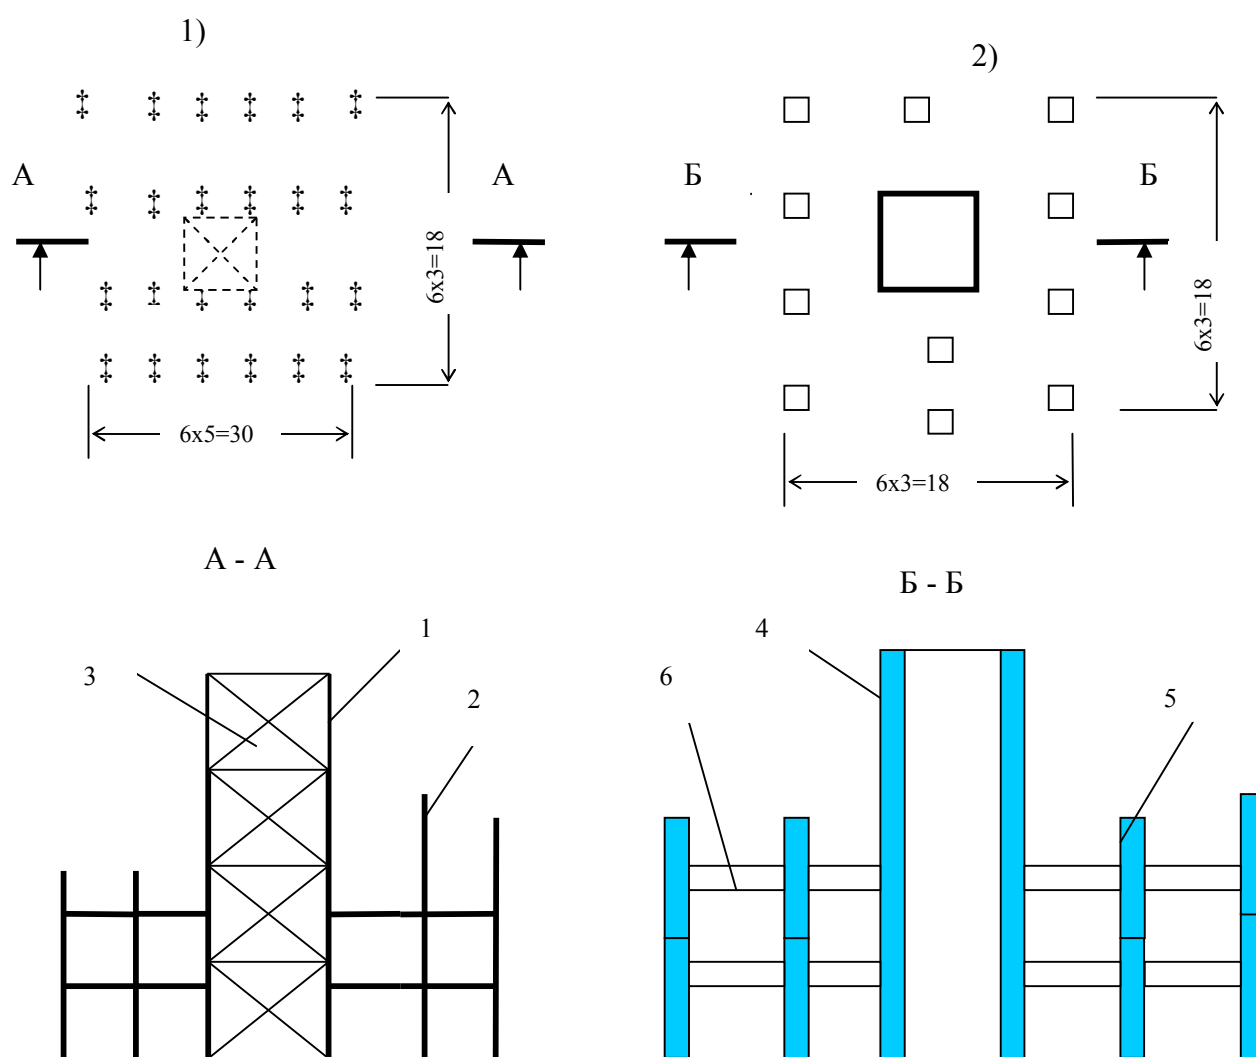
Схемы высотных зданий: 1) - со стальным каркасом и ядром жёсткости; 2) - с железобетонным каркасом и ядром жёсткости и сборными плитами перекрытий; 1,4 – ядра жёсткости; 2 – металлический каркас; 3 – металлические связи; 5 – железобетонные вертикальные конструкции каркаса; 6 – сборные плиты перекрытий.
